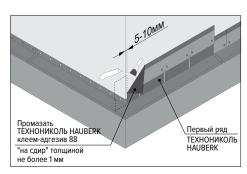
Монтаж второго и последующих рядов фасадной плитки
